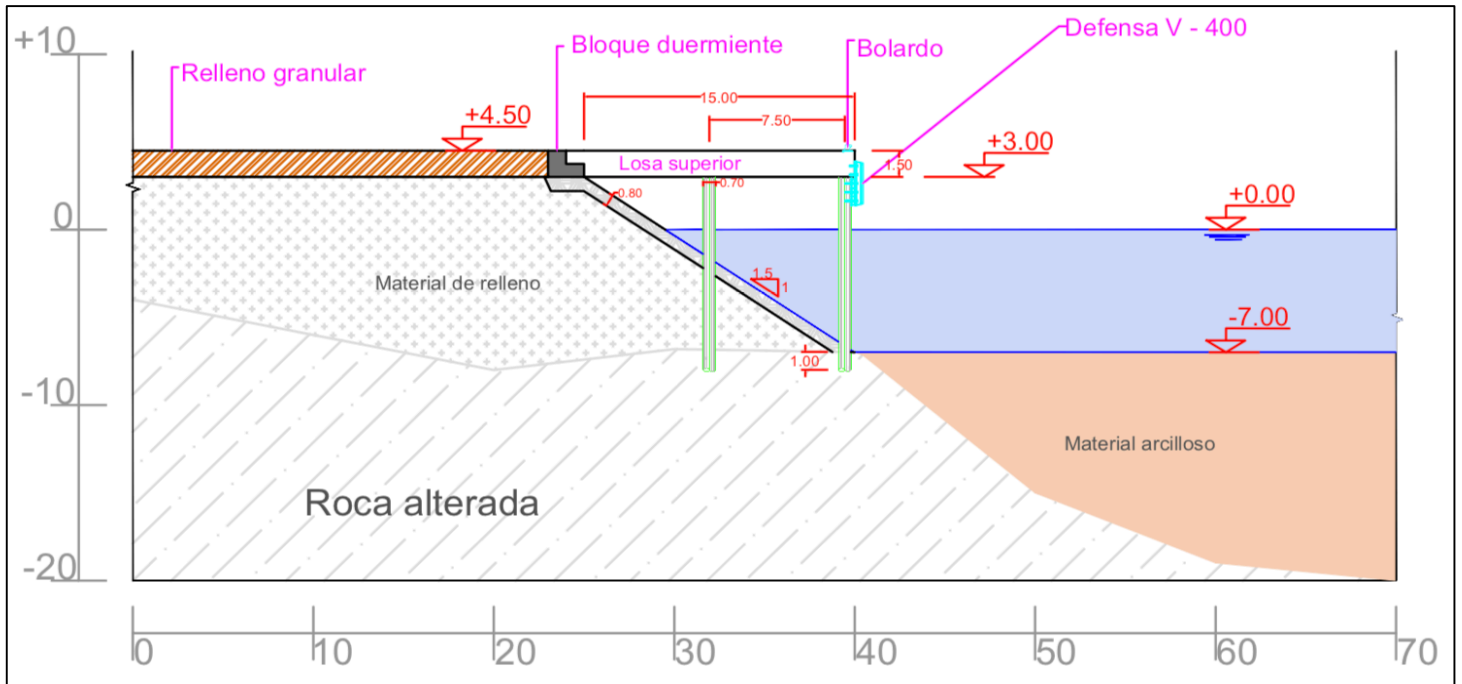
Croquis de la alternativa 2 (En ningún caso se puede usar como plano constructivo)
